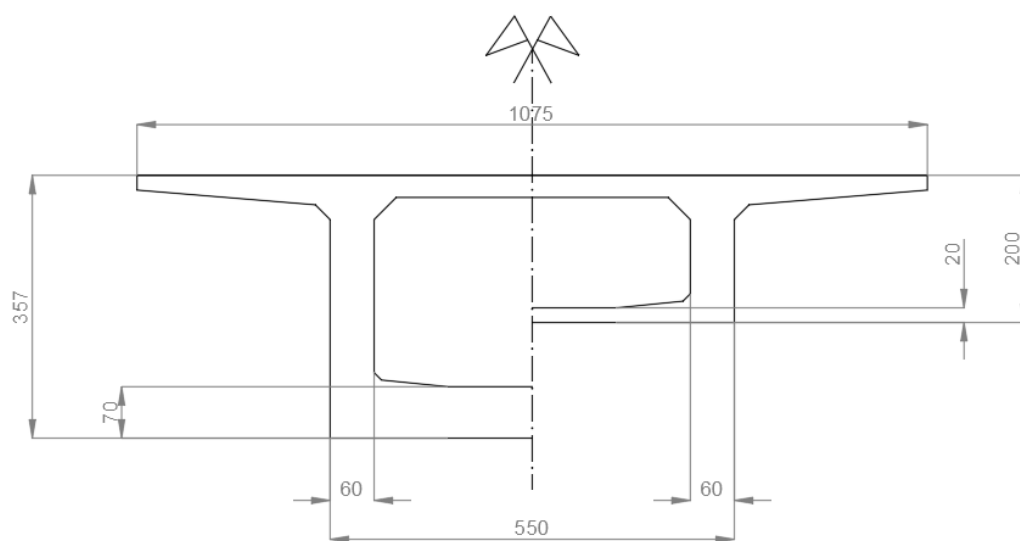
Sezione sulle pile a sinistra, sezione sulle spalle a destra
